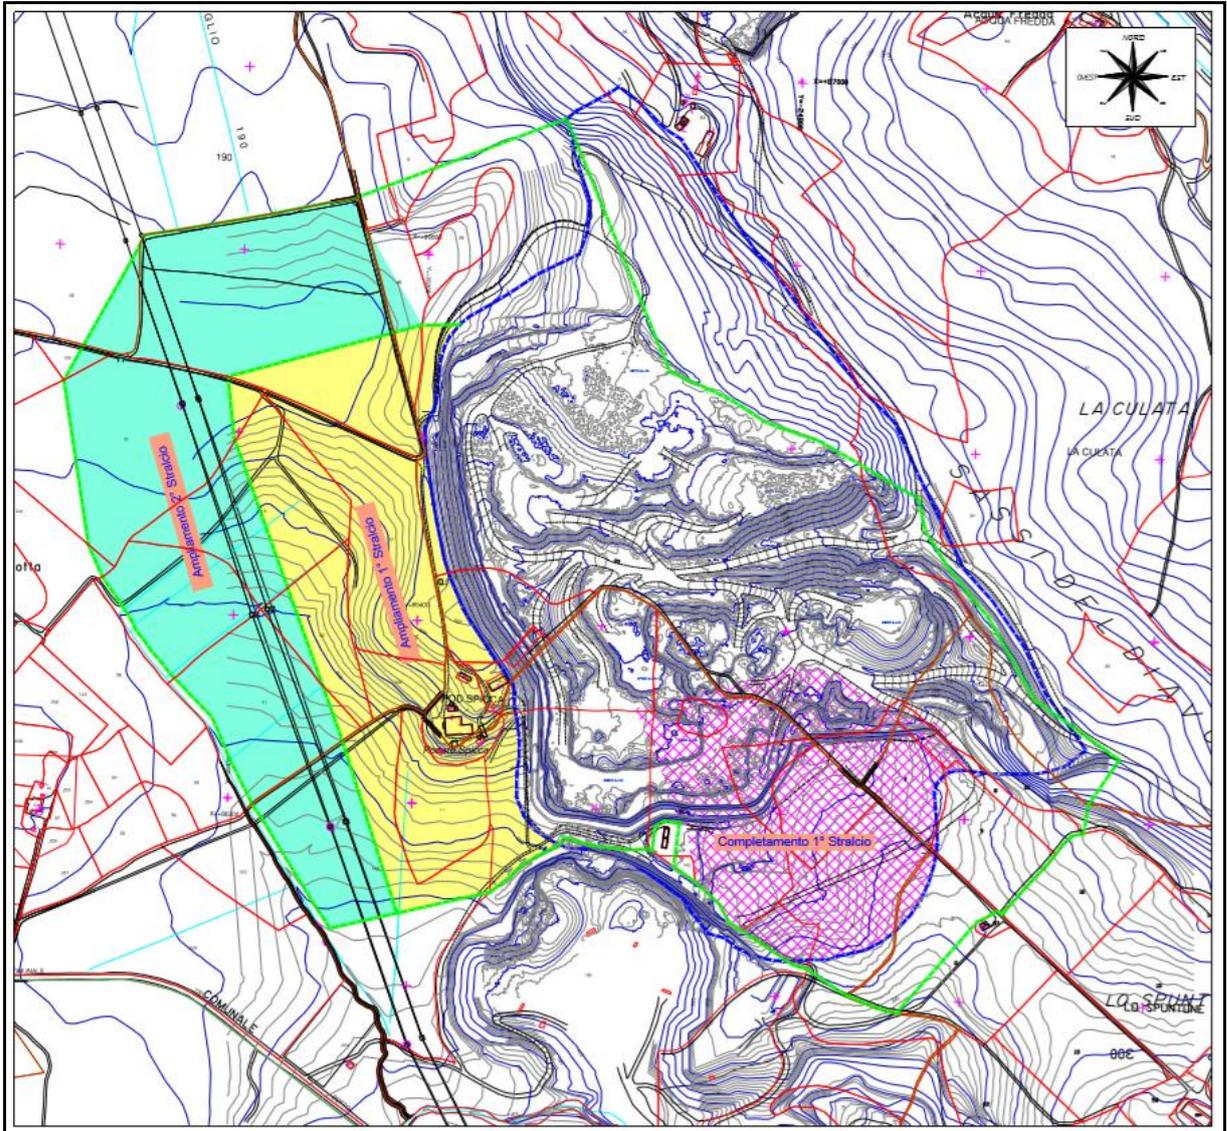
Stralcio Tav.4 Progetto Preliminare – individuazione Stralci Funzionali
